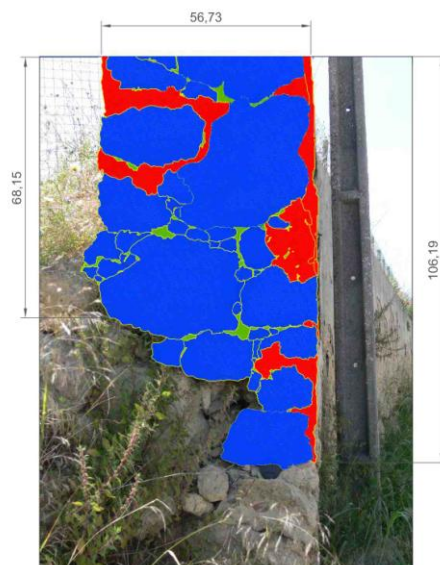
Elementos constituintes da secção transversal da Rua do Chafariz Público - Serrado
